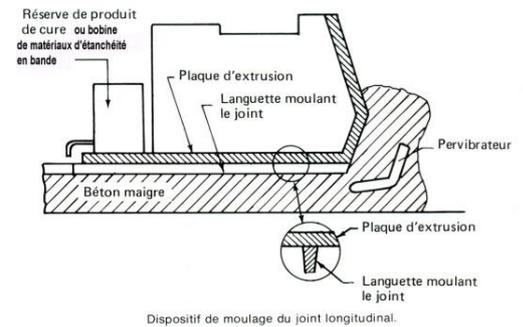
Schéma du dispositif de moulage du joint longitudinal par mise en place d'une réservation sous la plaque d'extrusion, dans la zone de vibration du béton
